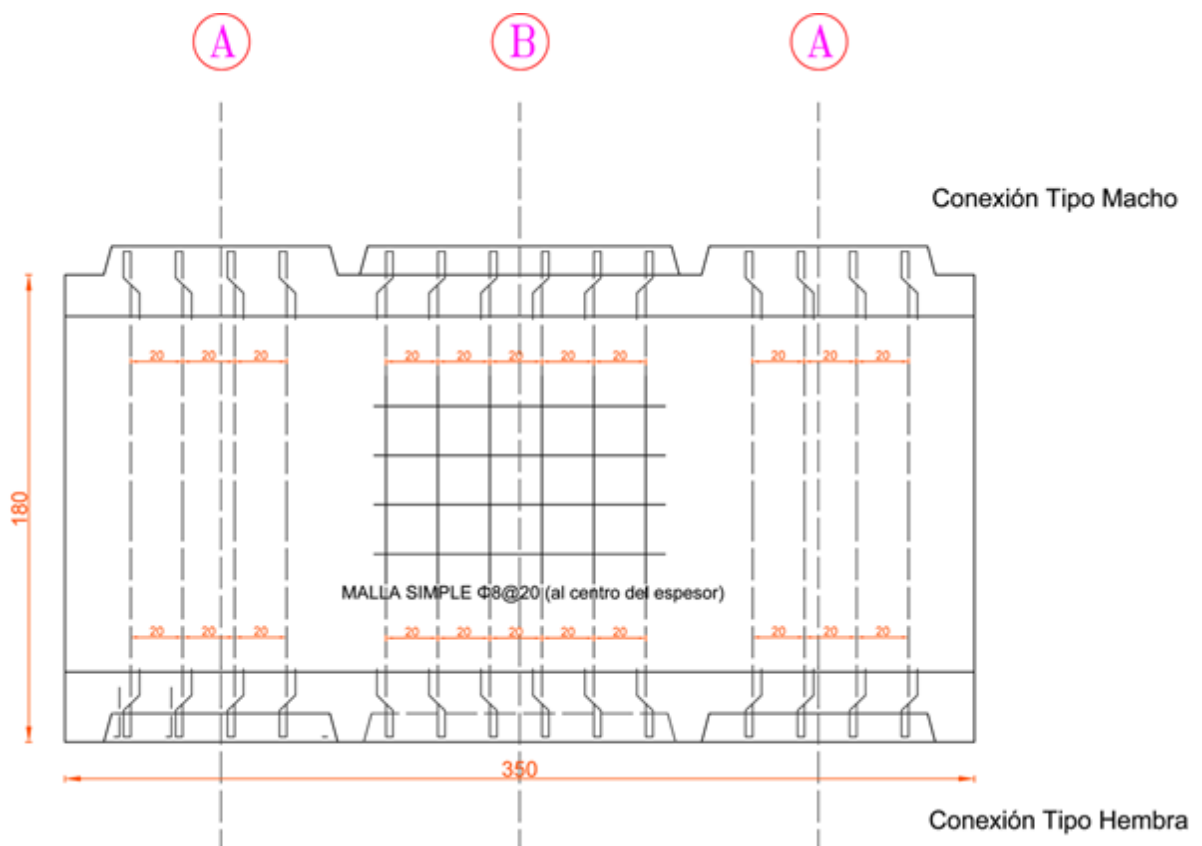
Armadura dientes conexión tipo macho y ranuras conexión tipo hembra.
